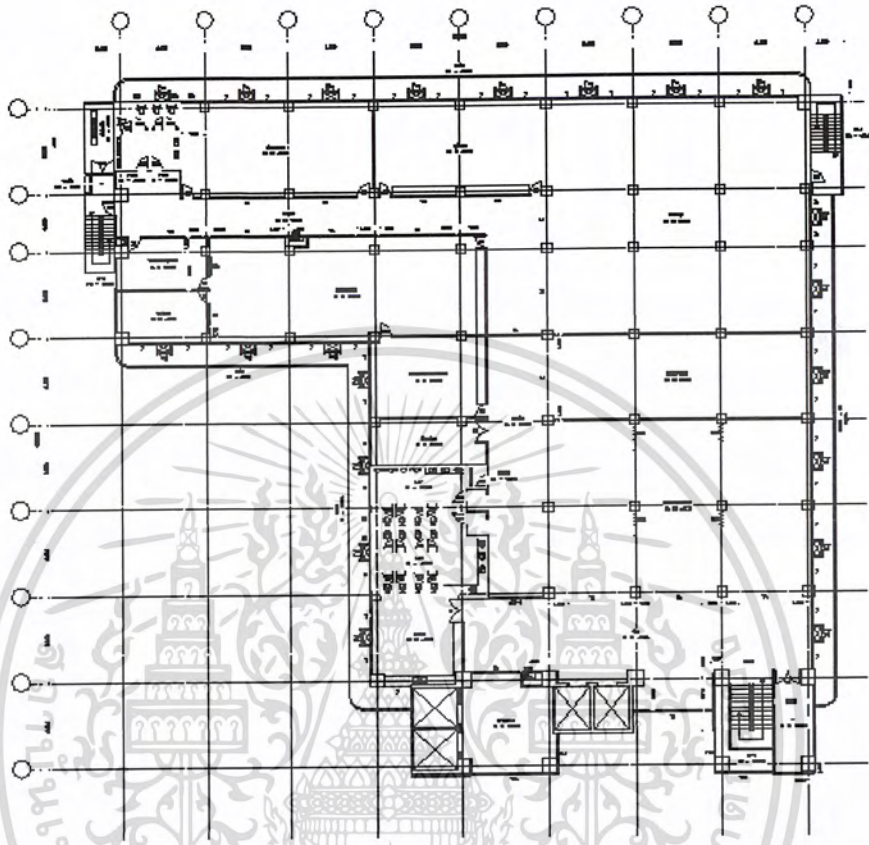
แสดงพื้นที่ชั้น 5 th - 7 th FLOOR PLAN
